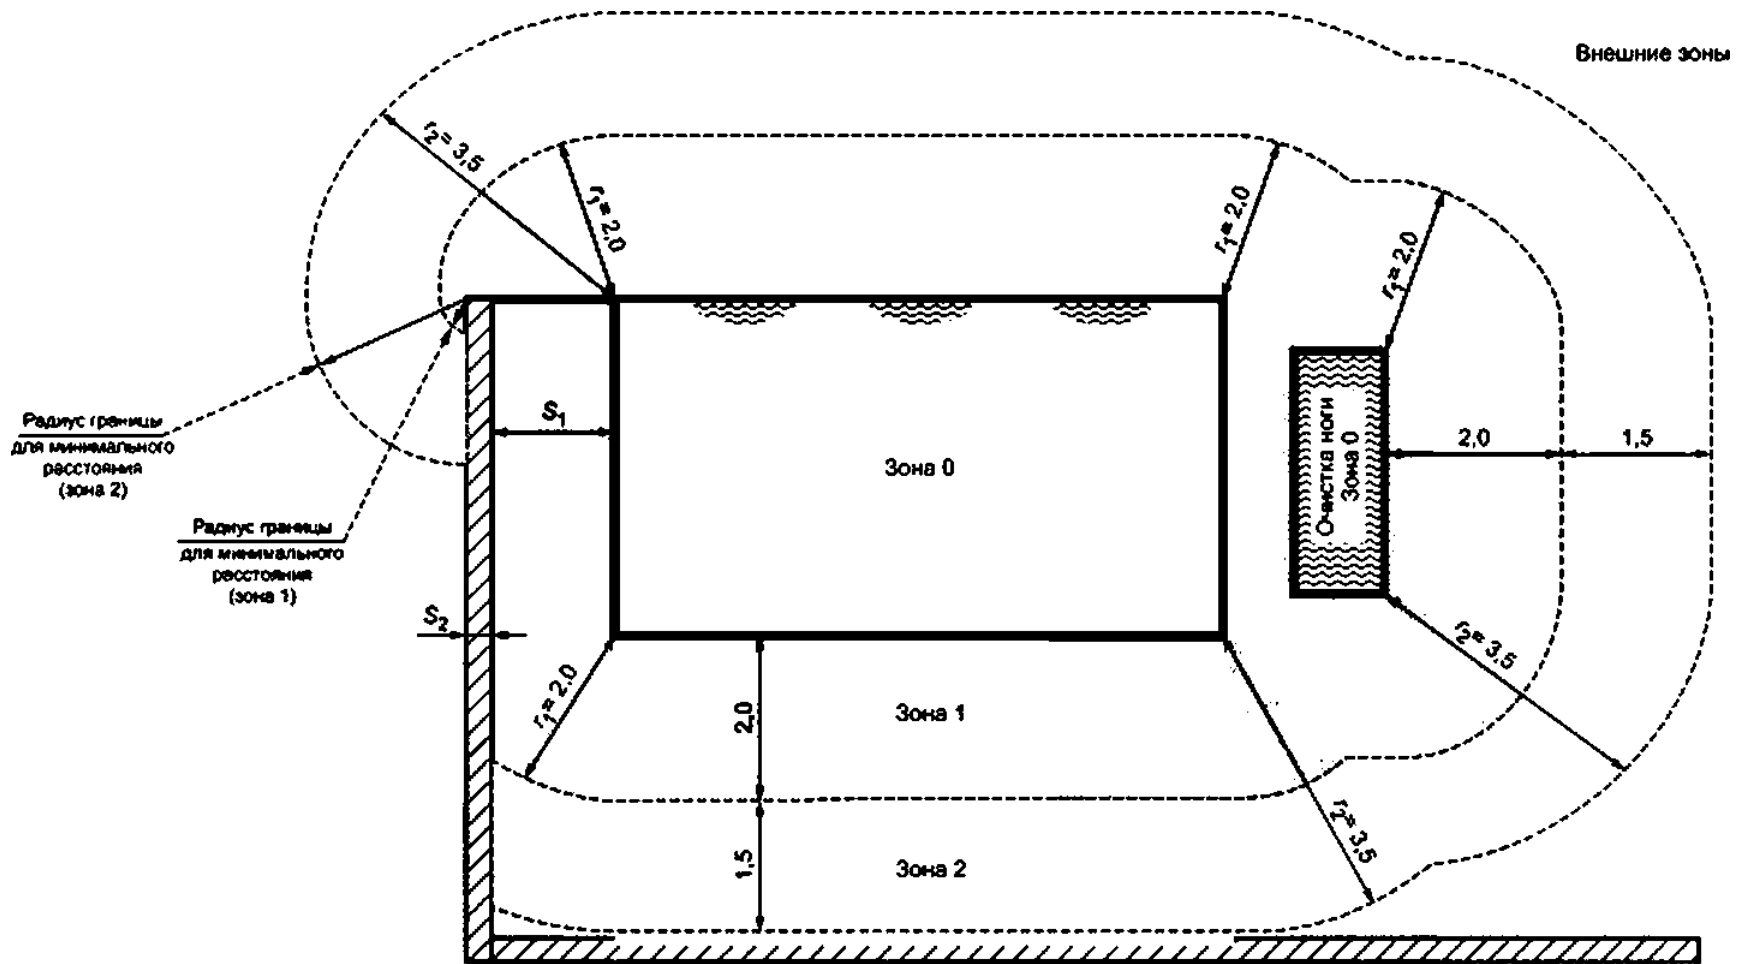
Размеры зон для плавательных бассейнов и лягушатников (вид сбоку)
